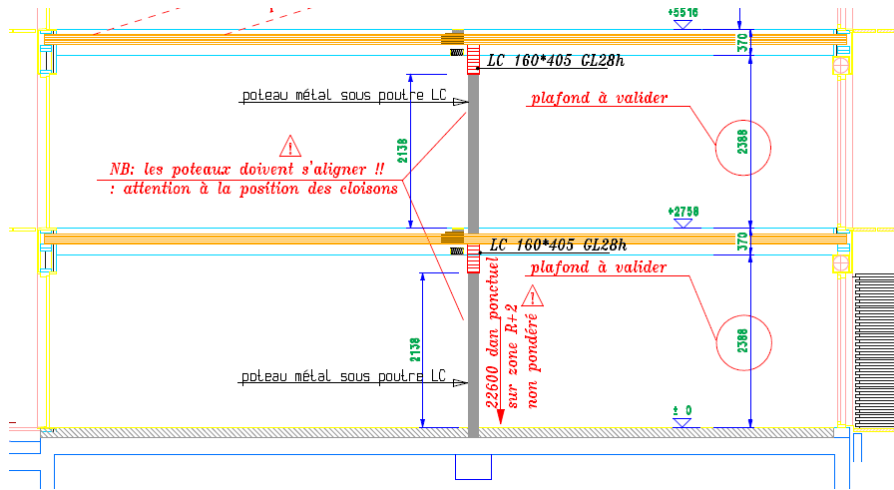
Poutre en bois lamellé collé coupe la portée du plancher KLH
